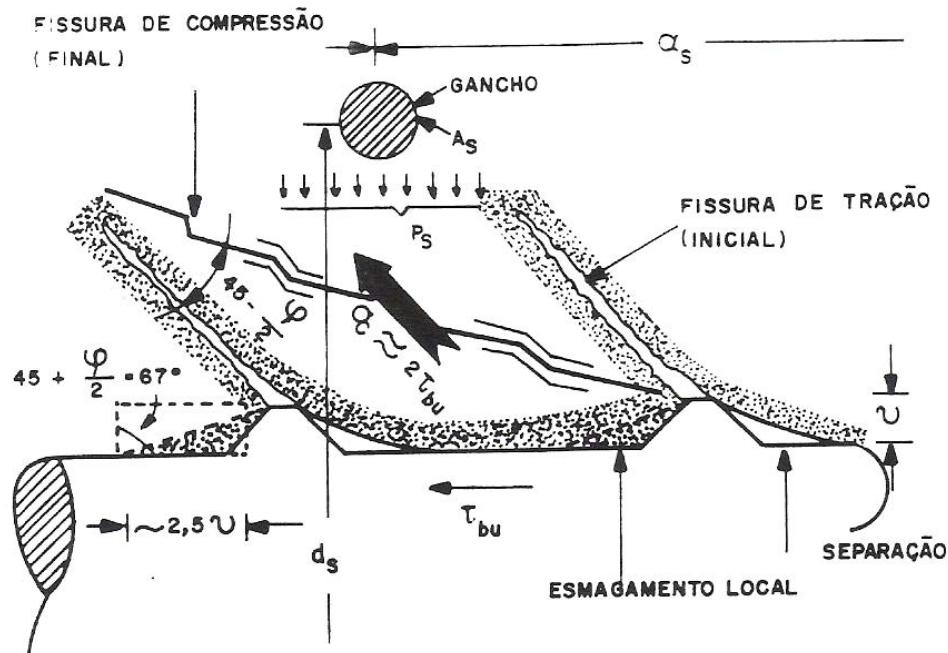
Ruptura do dente de concreto e pressão favorável da armadura de confinamento
